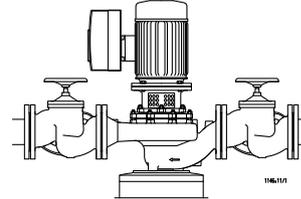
Vertikaler Einbau / Befestigung mit Pumpenfuß (Zubehör, auf Anfrage möglich)
